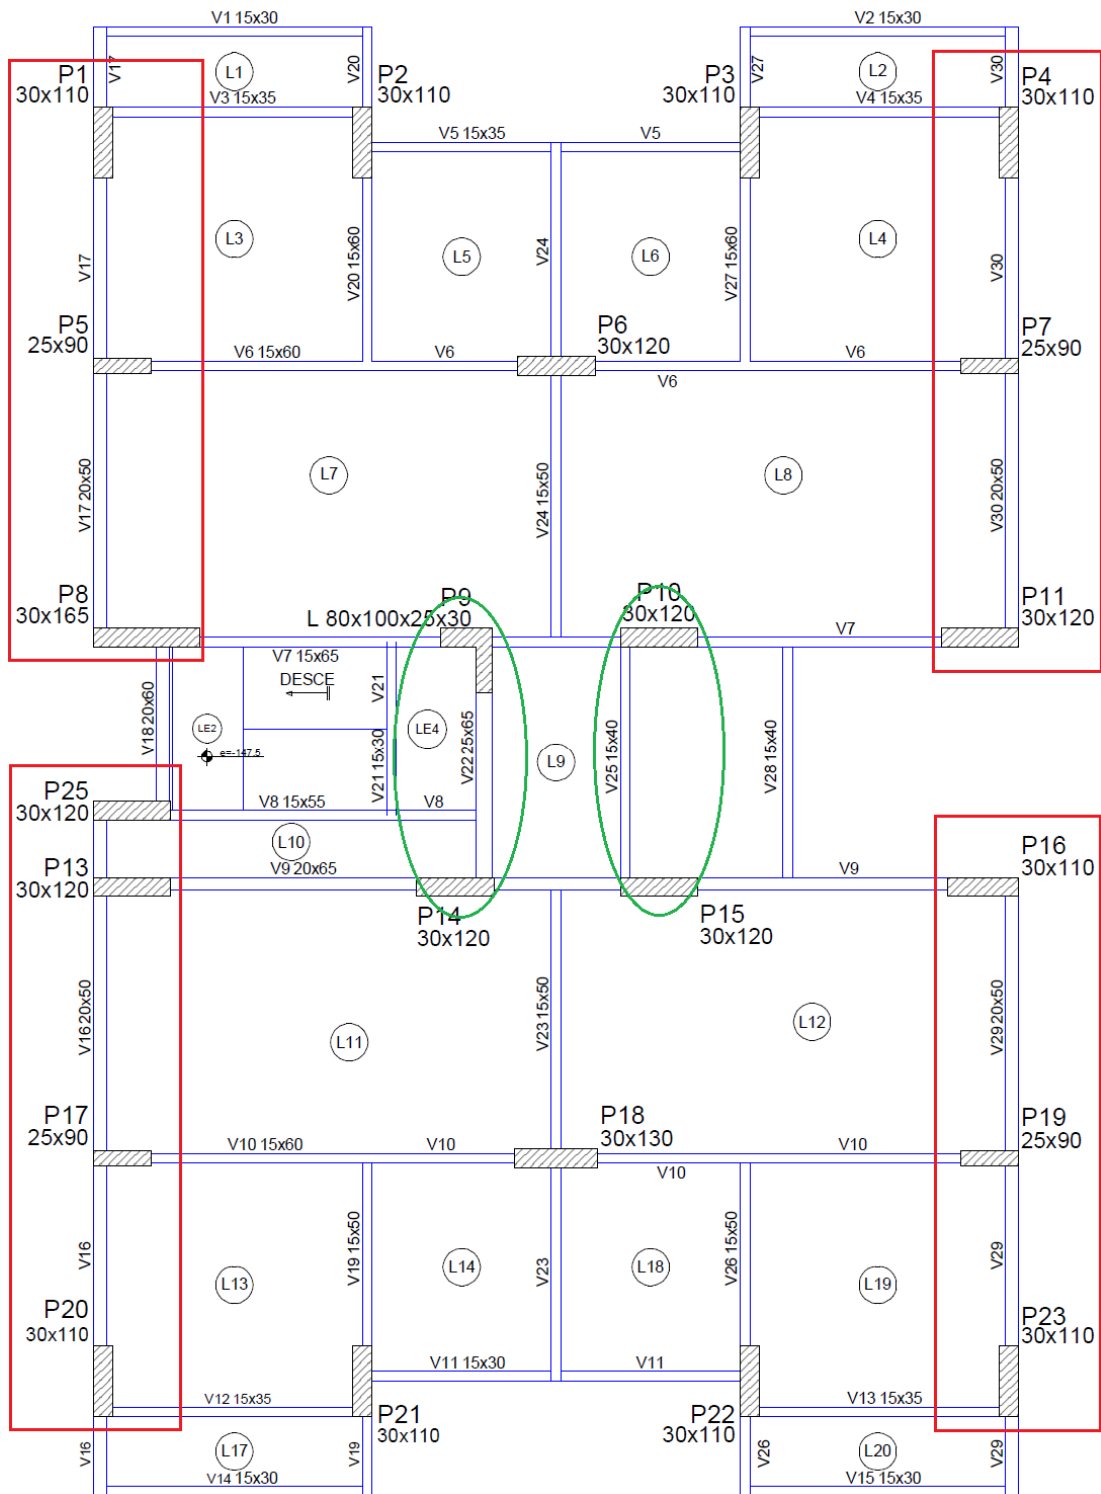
Planta de forma do pavimento tipo - Modelo Estrutural com Pórticos de contraventamento na direção "x".
